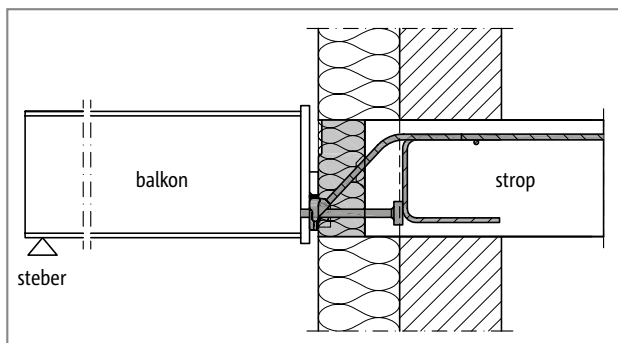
Schöck Isokorb® T tip SQP: priključek na železobetonski strop; monolitna konstrukcija stene
